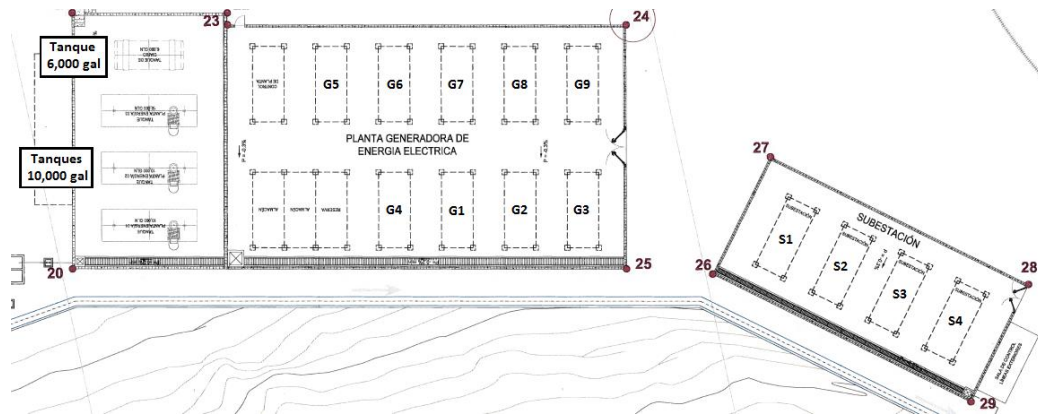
Vista en planta de Planta Generadora (Fuente: Expediente Técnico Final)
